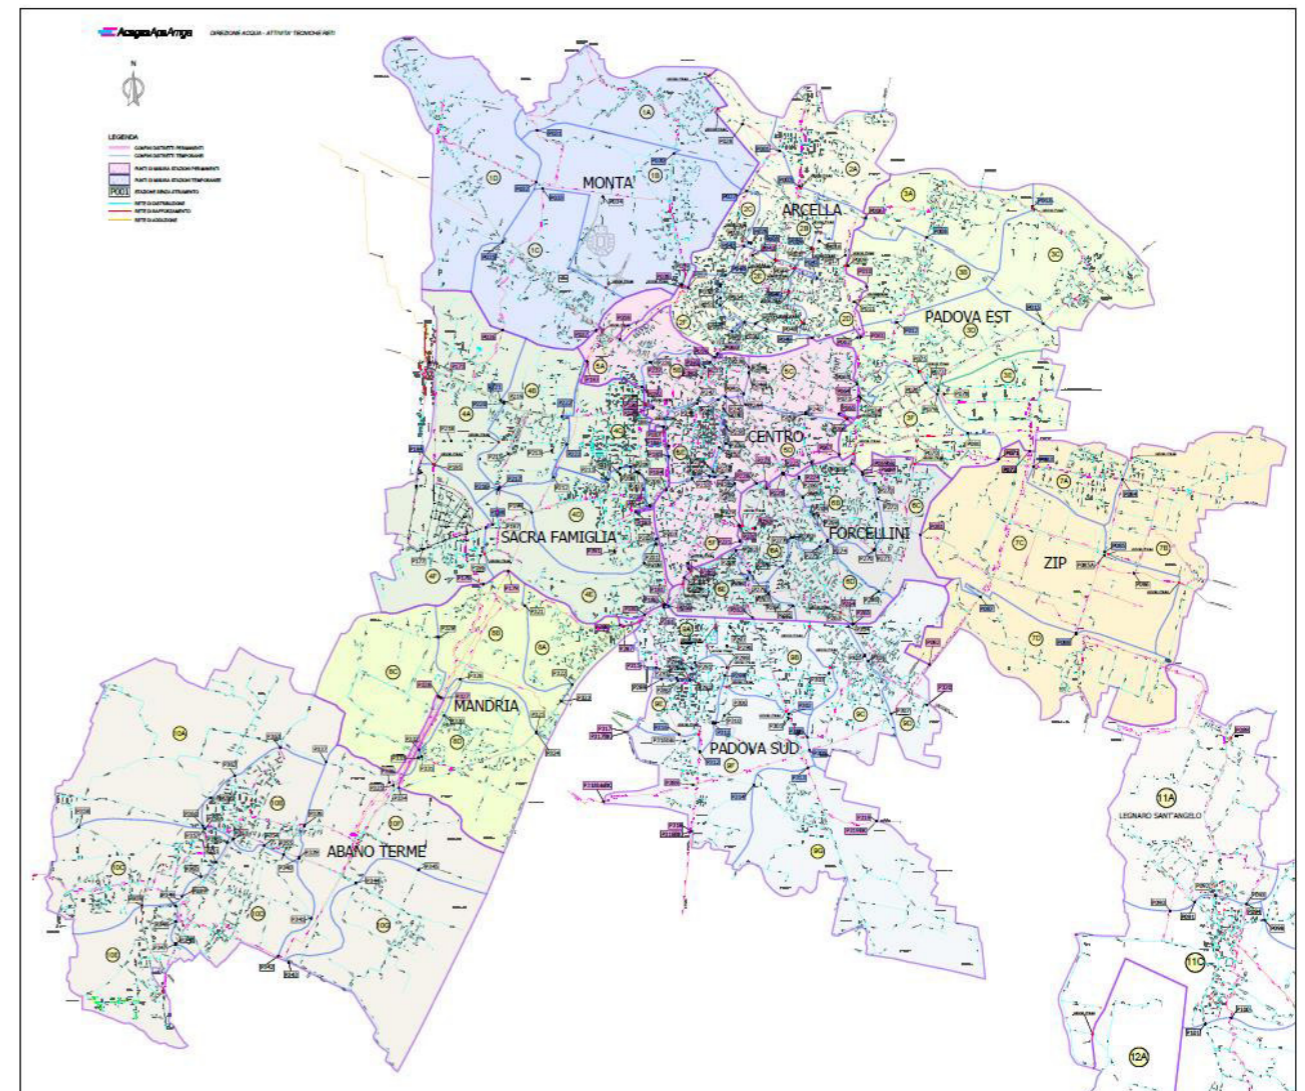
Planimetria generale acquedotto di Padova - Fonte: AcegasApsAmga
